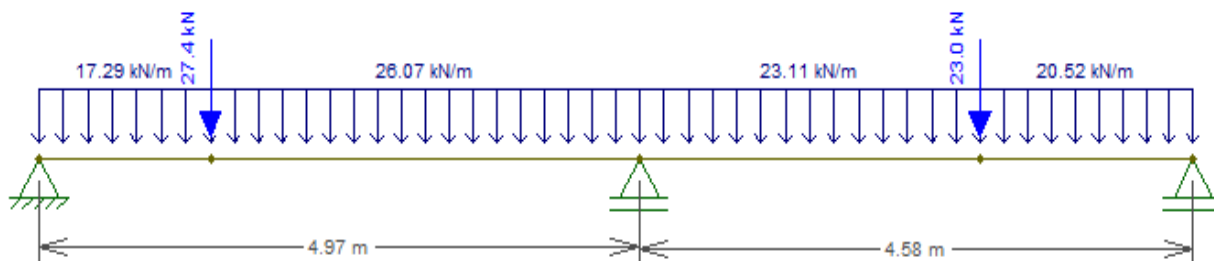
Esquema estrutural - Viga 8 (a e b) (Tipo).
